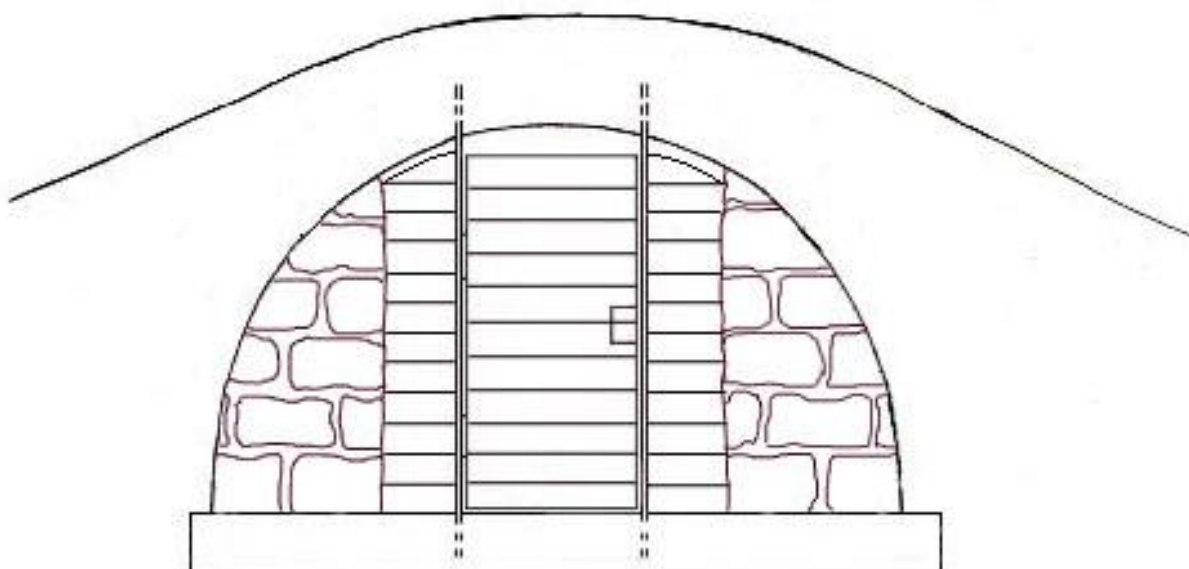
Schéma du dispositif de fermeture à mettre en place pour la cave de Barlette
